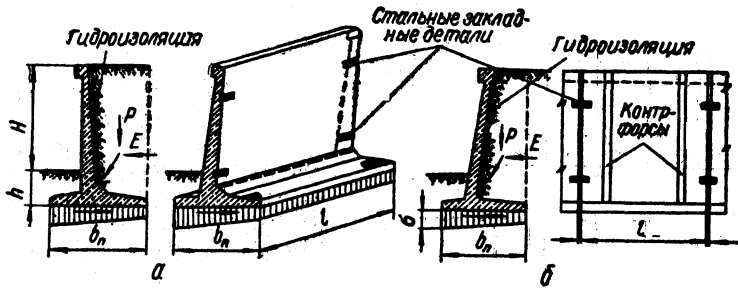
Железобетонные подпорные стенки из сборных объемных блоков углового профиля:
